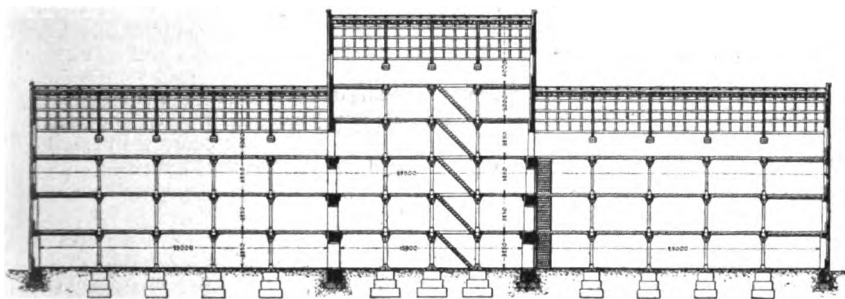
Gebäude einer Reisstärkefabrik in Cement-Eisenkonstruktion.
